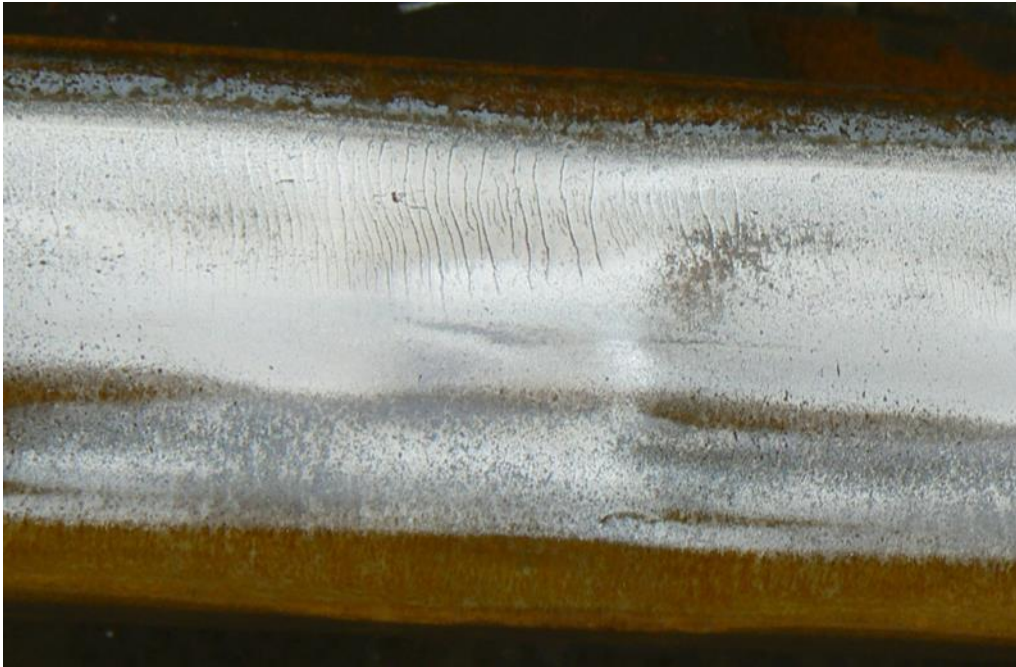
Fisuras transversales sobre el hongo sobre vía en el PK 10,885
